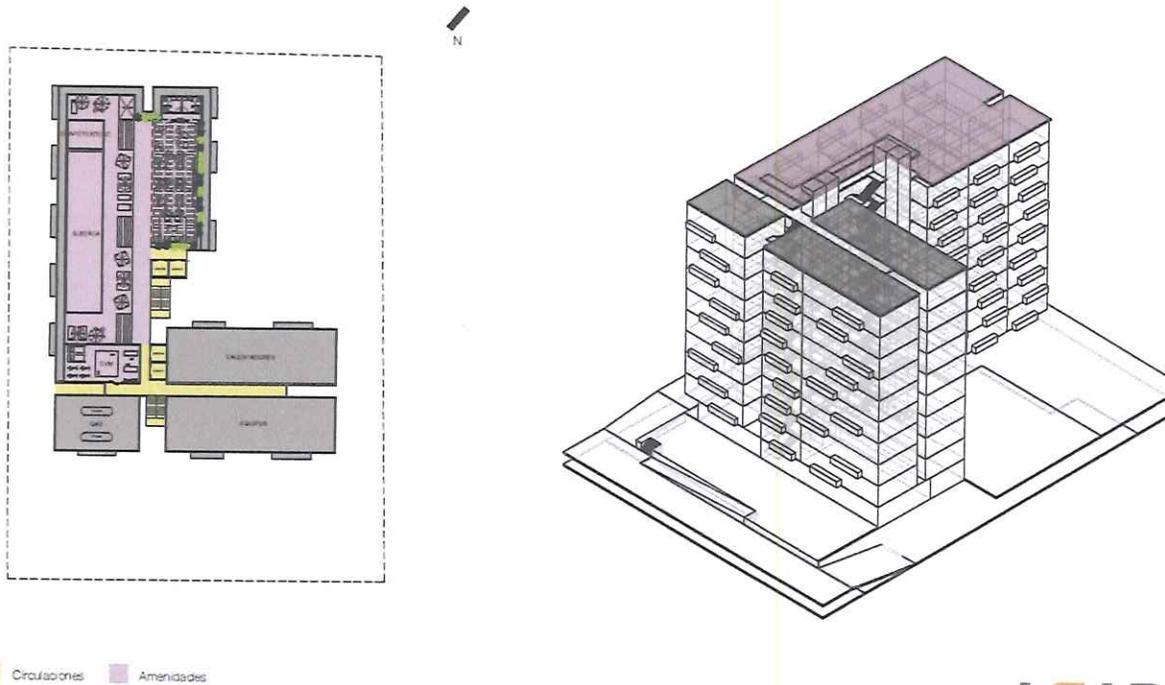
Planta arquitectónica distribución del nivel Azotea, Fuente: Plano Arquitectónico.
